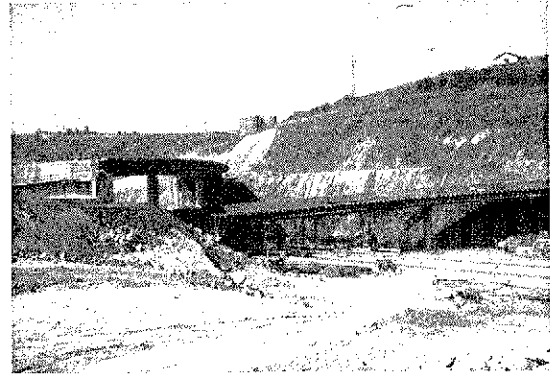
Puente 1 descimbrado y vista de la cimbra y encofrado del tablero del puente 2.
